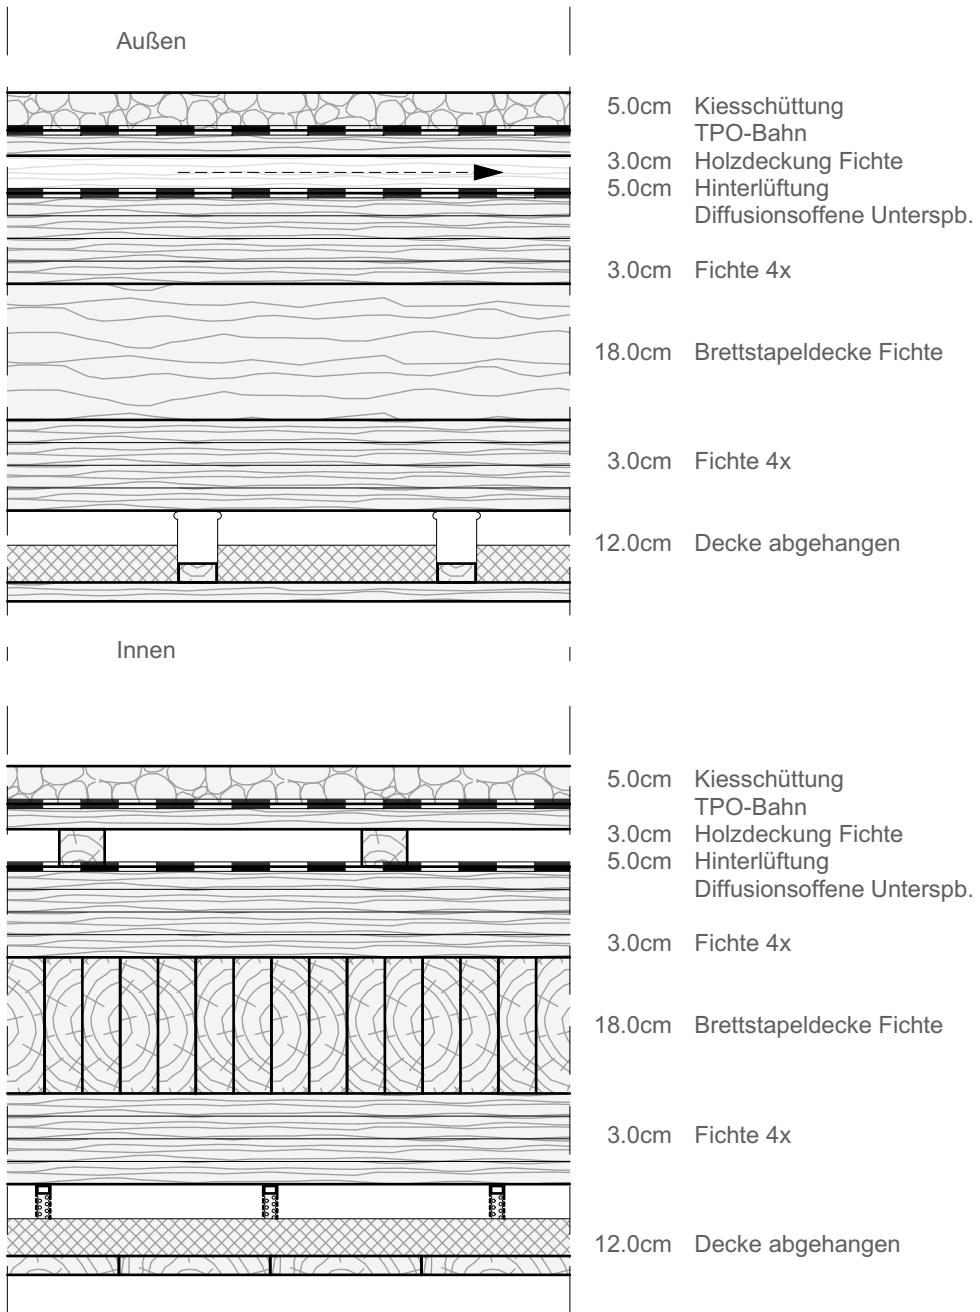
Annahme Flachdachaufbau ohne Neigung - Detail M 1:10
